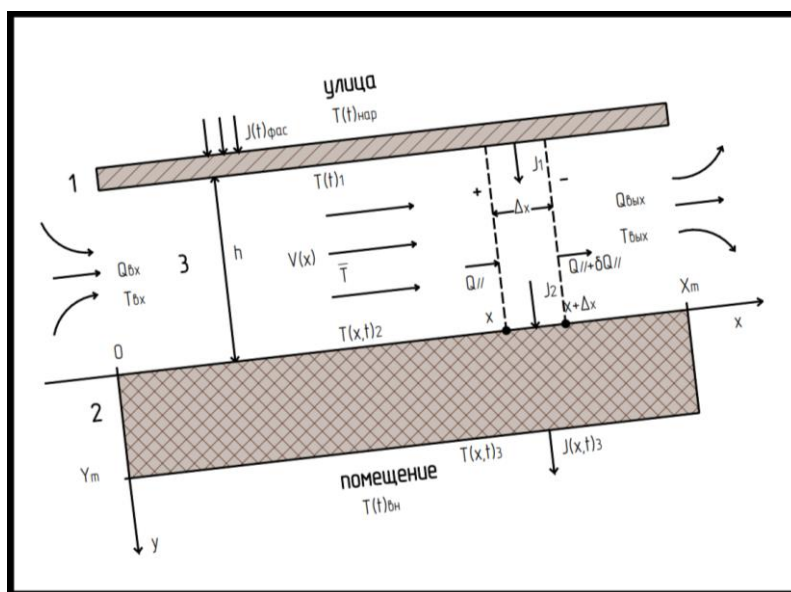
Схематическое устройство фасадной системы с плоским вентилируемым зазором [15]:
